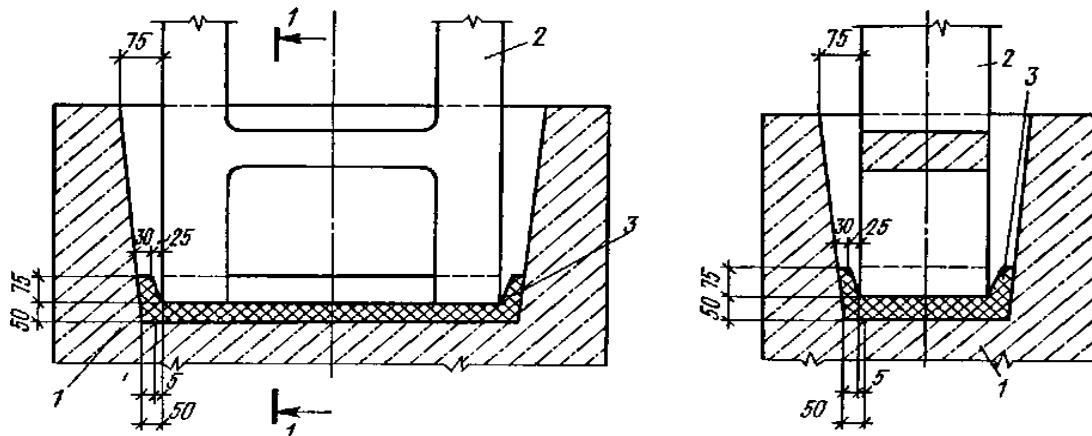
Опирание сборных железобетонных колонн на фундаменты стаканного типа:
